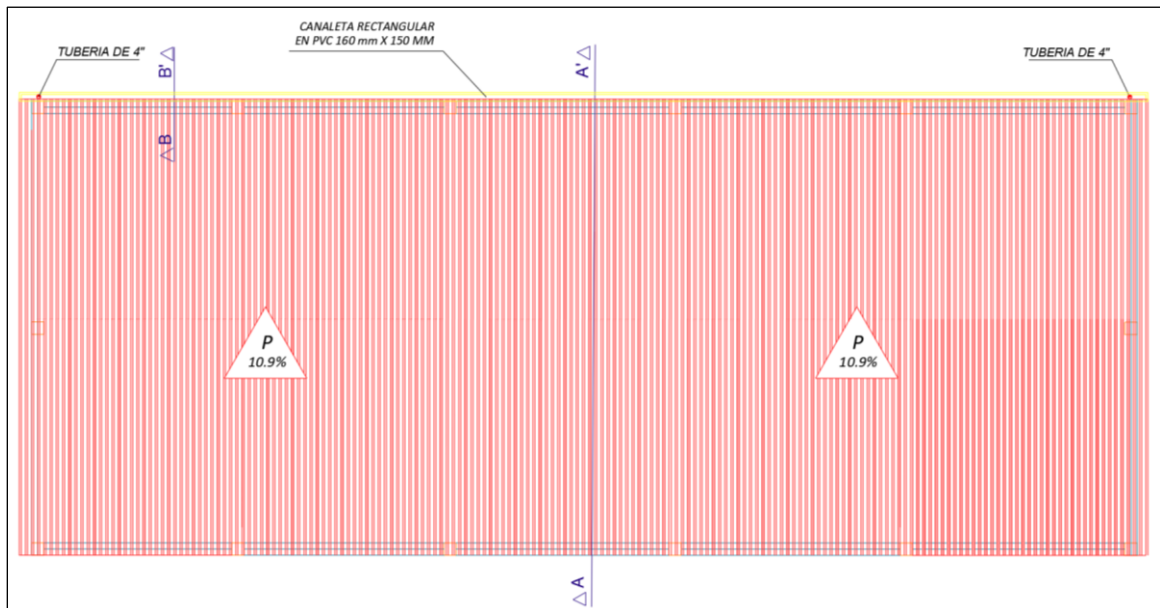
Vista en planta de tejado de la estructura 4 del Centro de Desarrollo Infantil.
